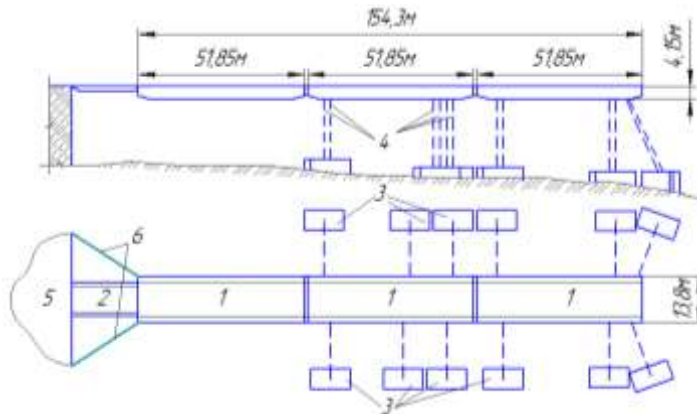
Общий вид плавучего причала: 1 – железобетонный понтон; 2 – металлический мост; 3 – железобетонные якоря; 4 – якорные цепи; 5 – берег, 6 – амортизирующие штанги.
